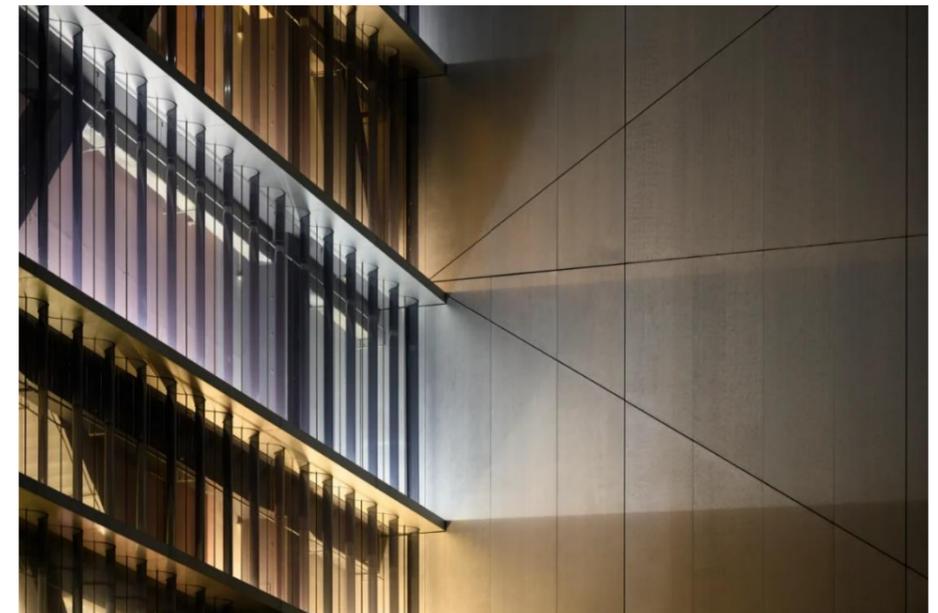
Encuentro entre fachada de vidrio ondulado y esfera metálica
